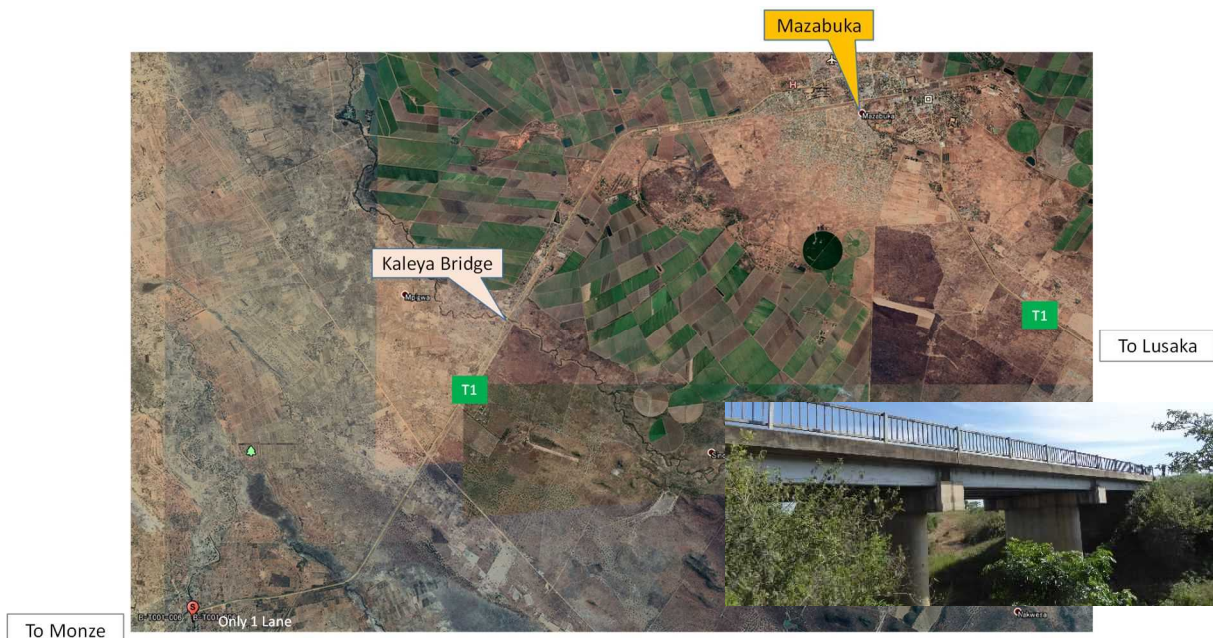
Southern RO における遠隔指導の対象橋梁 (Kaley Bridge)
